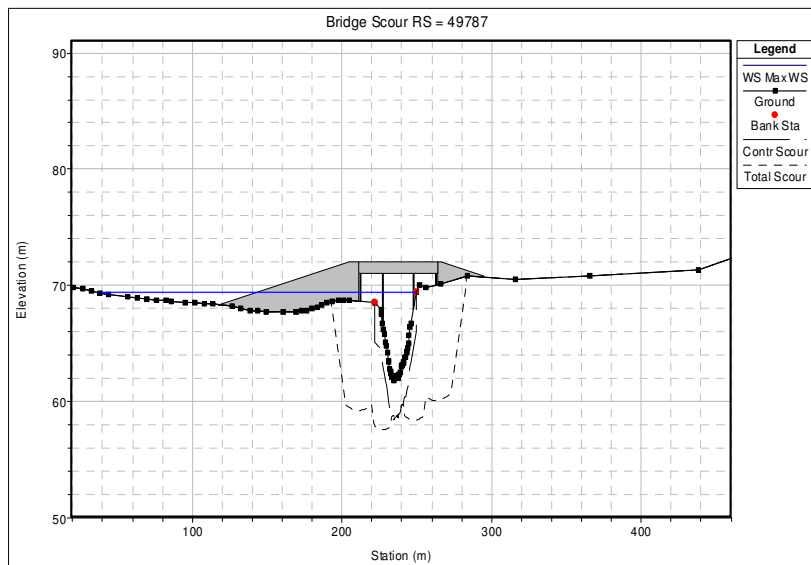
Puente en Piedra Grande - Perfil Transversal erosionado – d50: 1.00mm
